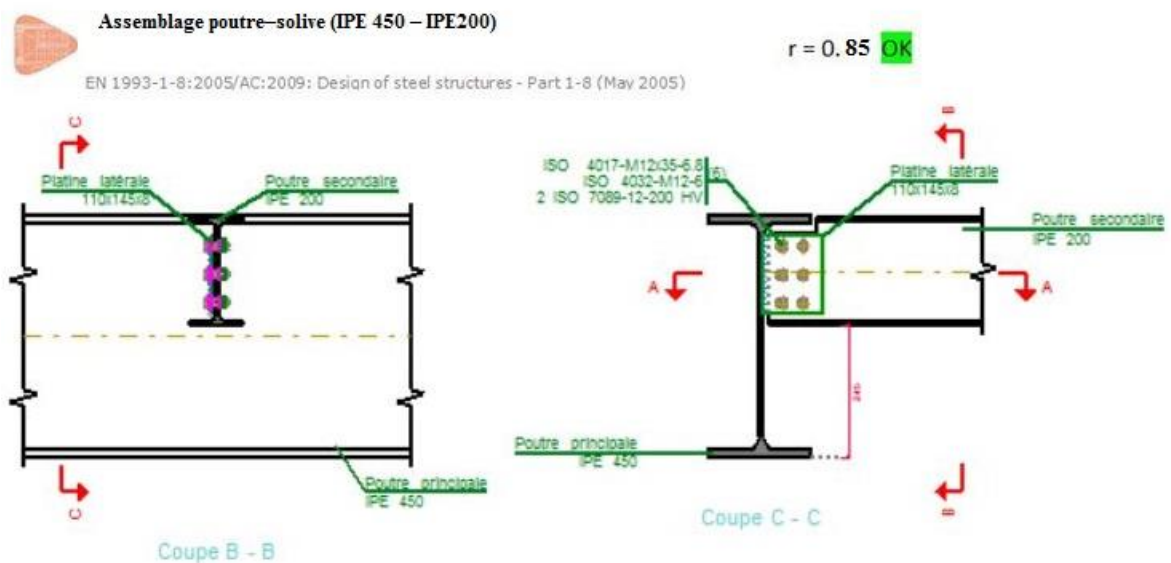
Vérification d'assemblage poutre-solive par cype-conect
